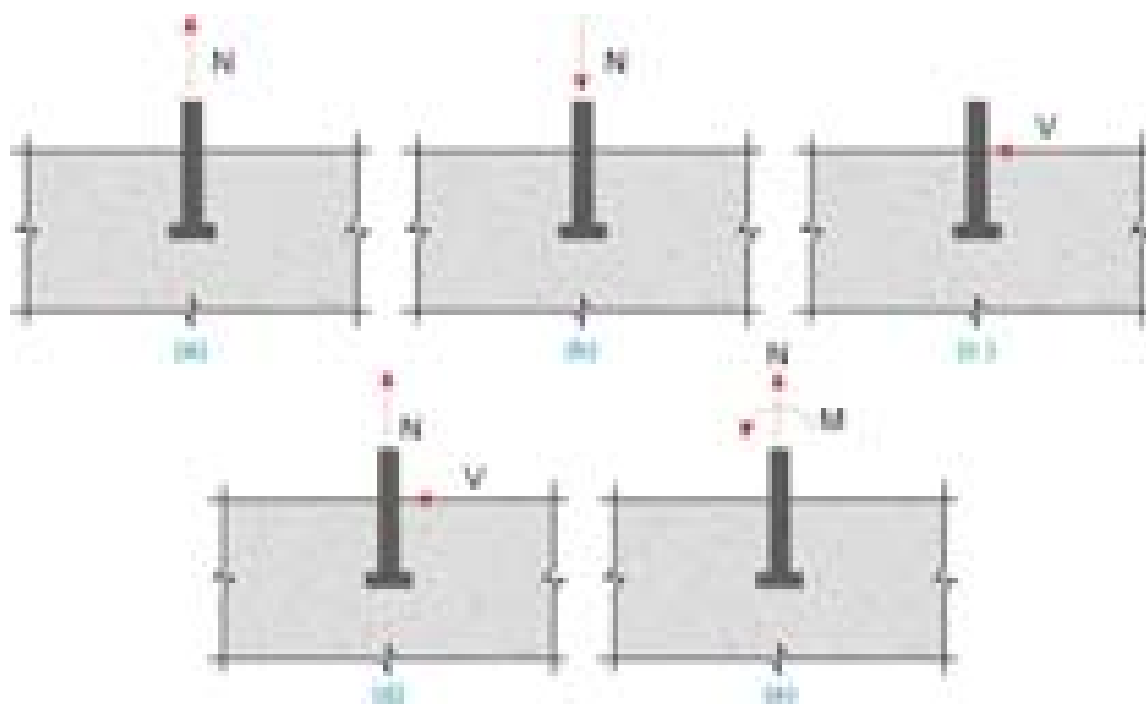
Tipos de solicitações. (a) tração. (b) compressão. (c) cisalhamento. (d) tração e cisalhamento. (e) tração e momento.
